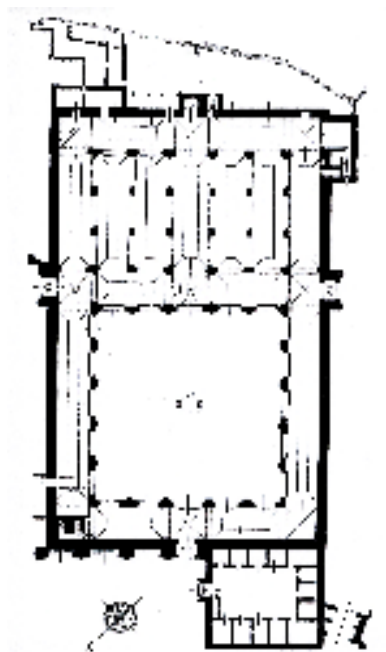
مسقط أفقي لجامع الكتبية الثاني بمراكش.
